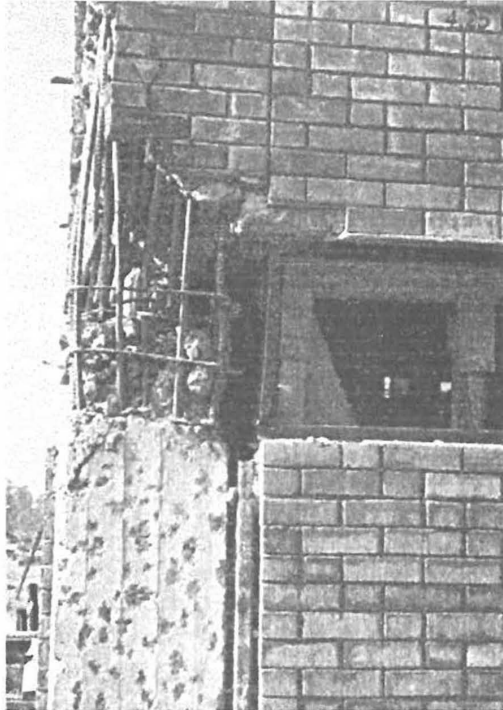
Terremoto de Chile en 1985. Columna corta extrema
